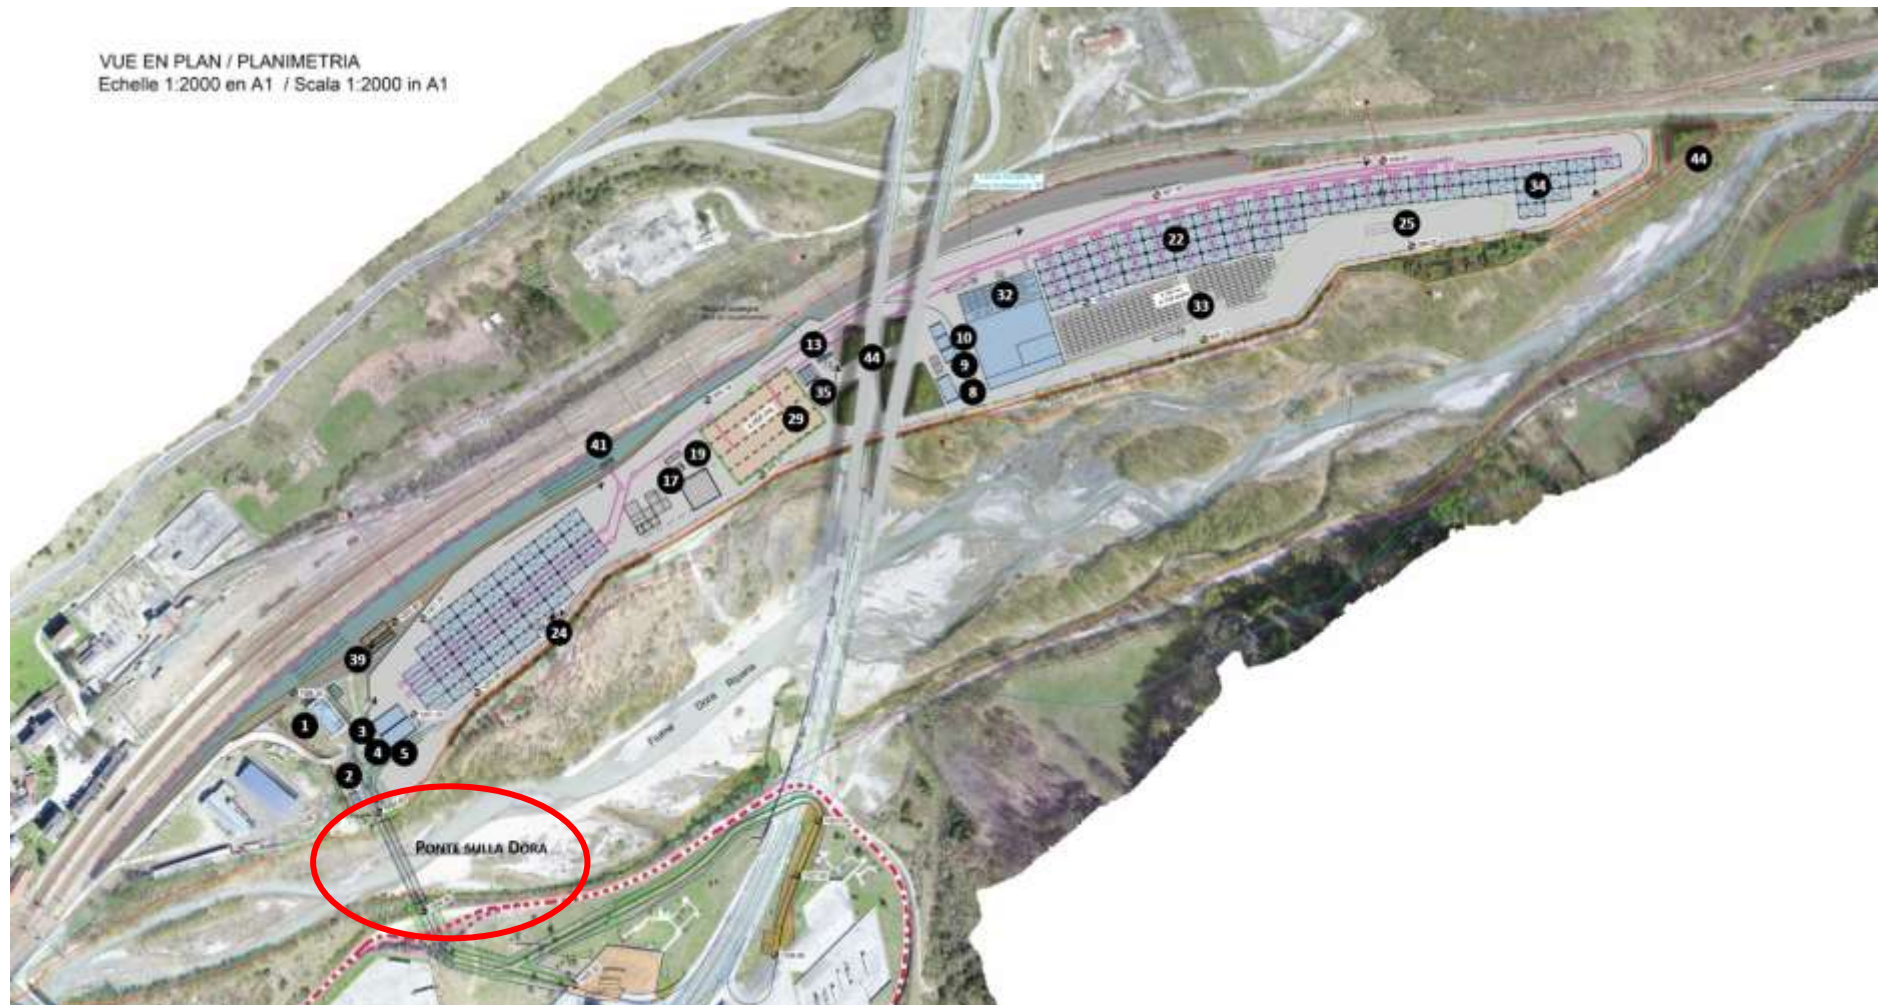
Planimetria area di cantiere in esercizio secondo il progetto definitivo in variane.
